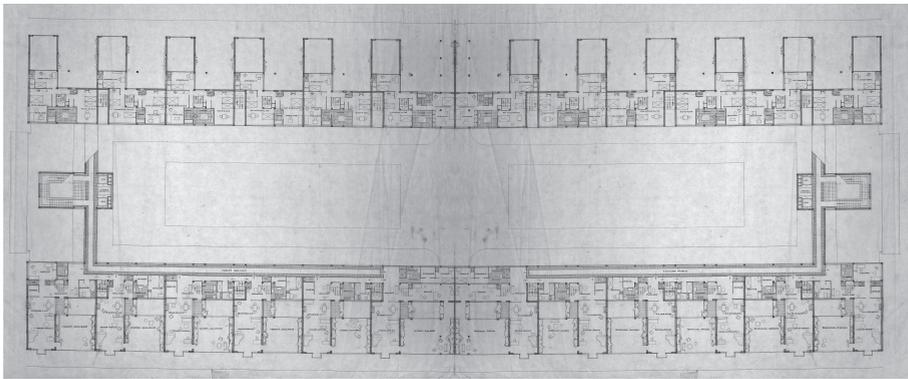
Planta do projecto Immeuble-villas de 1922 (montagem da autora).
